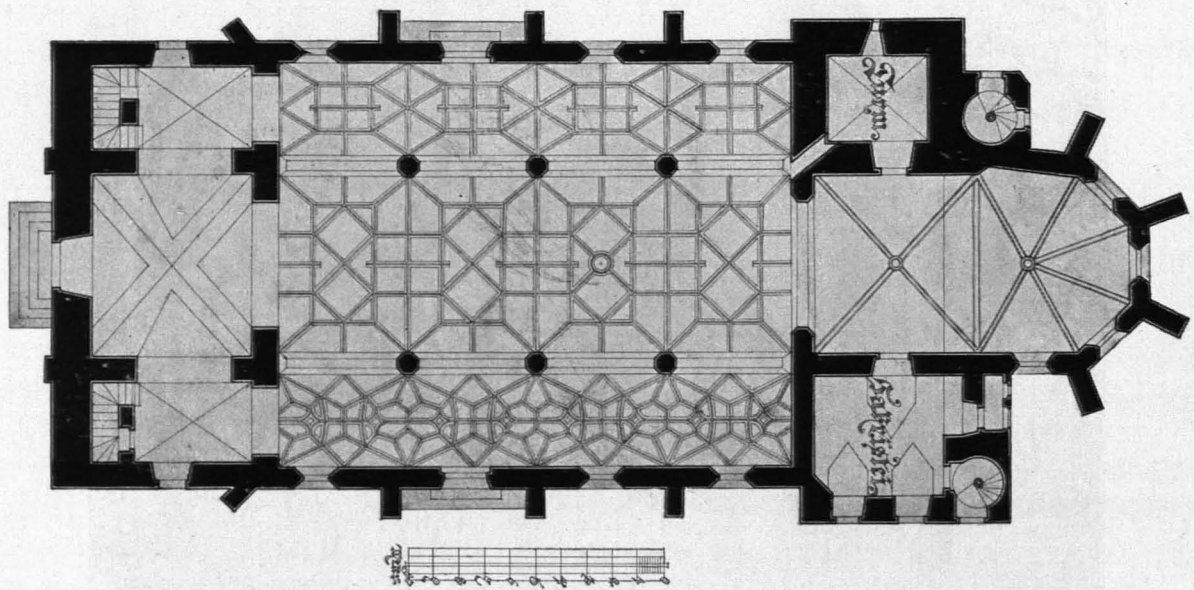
Mank, Pfarrkirche, Grundriß 1 : 300 (S. 131)
